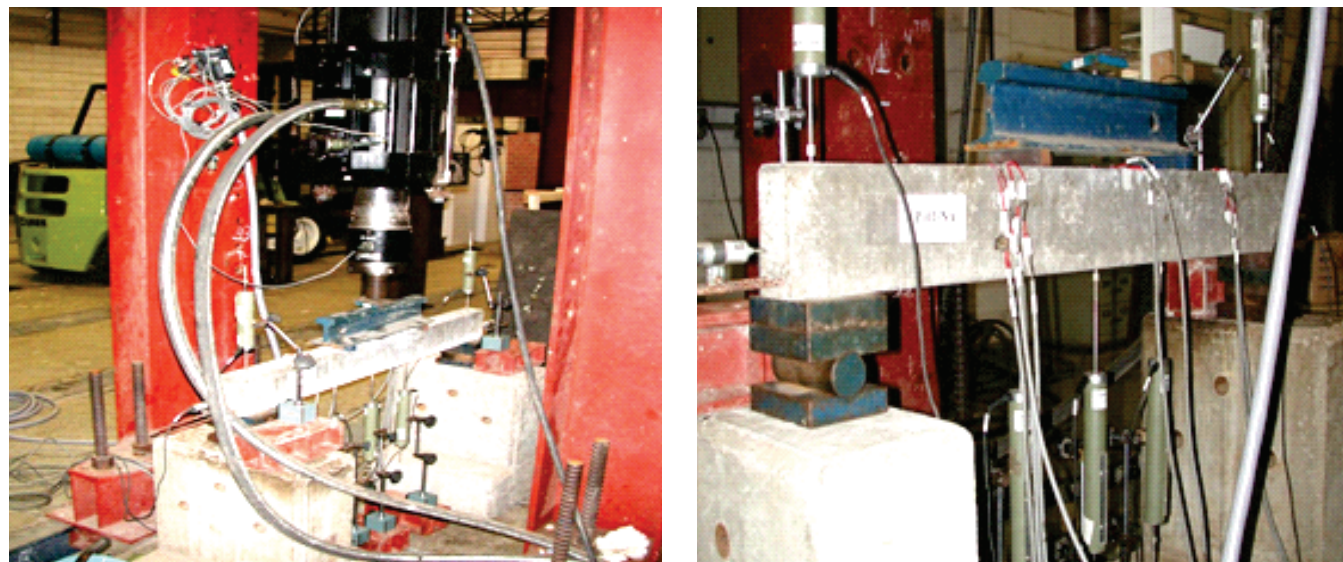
Pórtico de reação, aplicação das cargas e instrumentação das vigas
